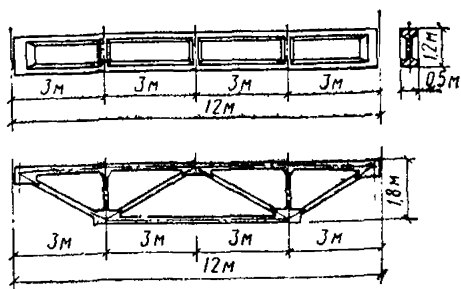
Продольная предварительно-напряженная балка и ферма для покрытий из панелей-оболочек КЖС при шаге колонн 12 м
